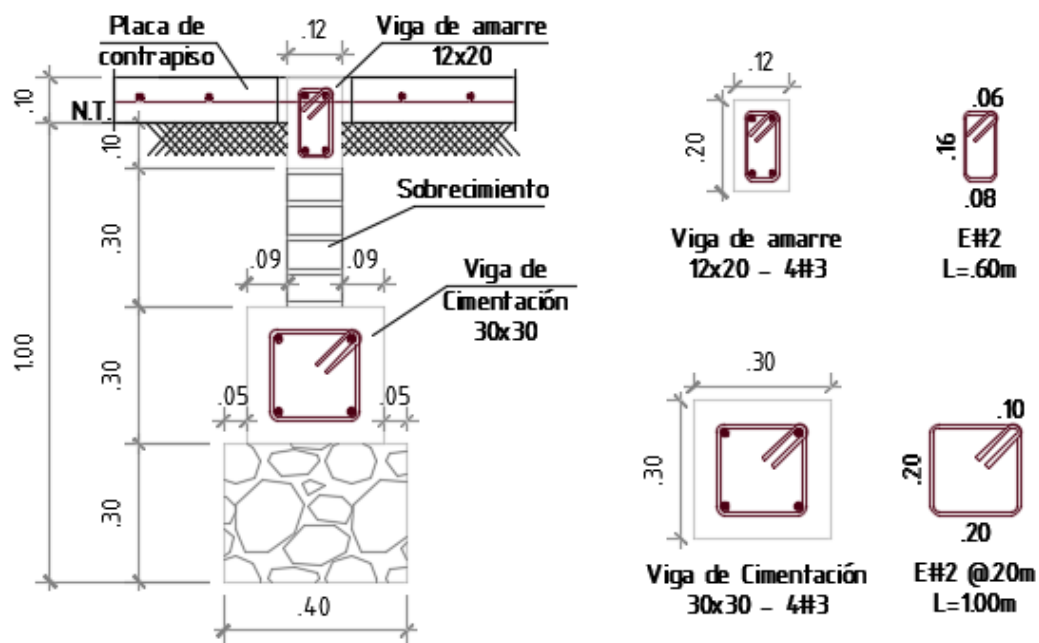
Detalle de cimentación continua para viviendas de mampostería confinada
